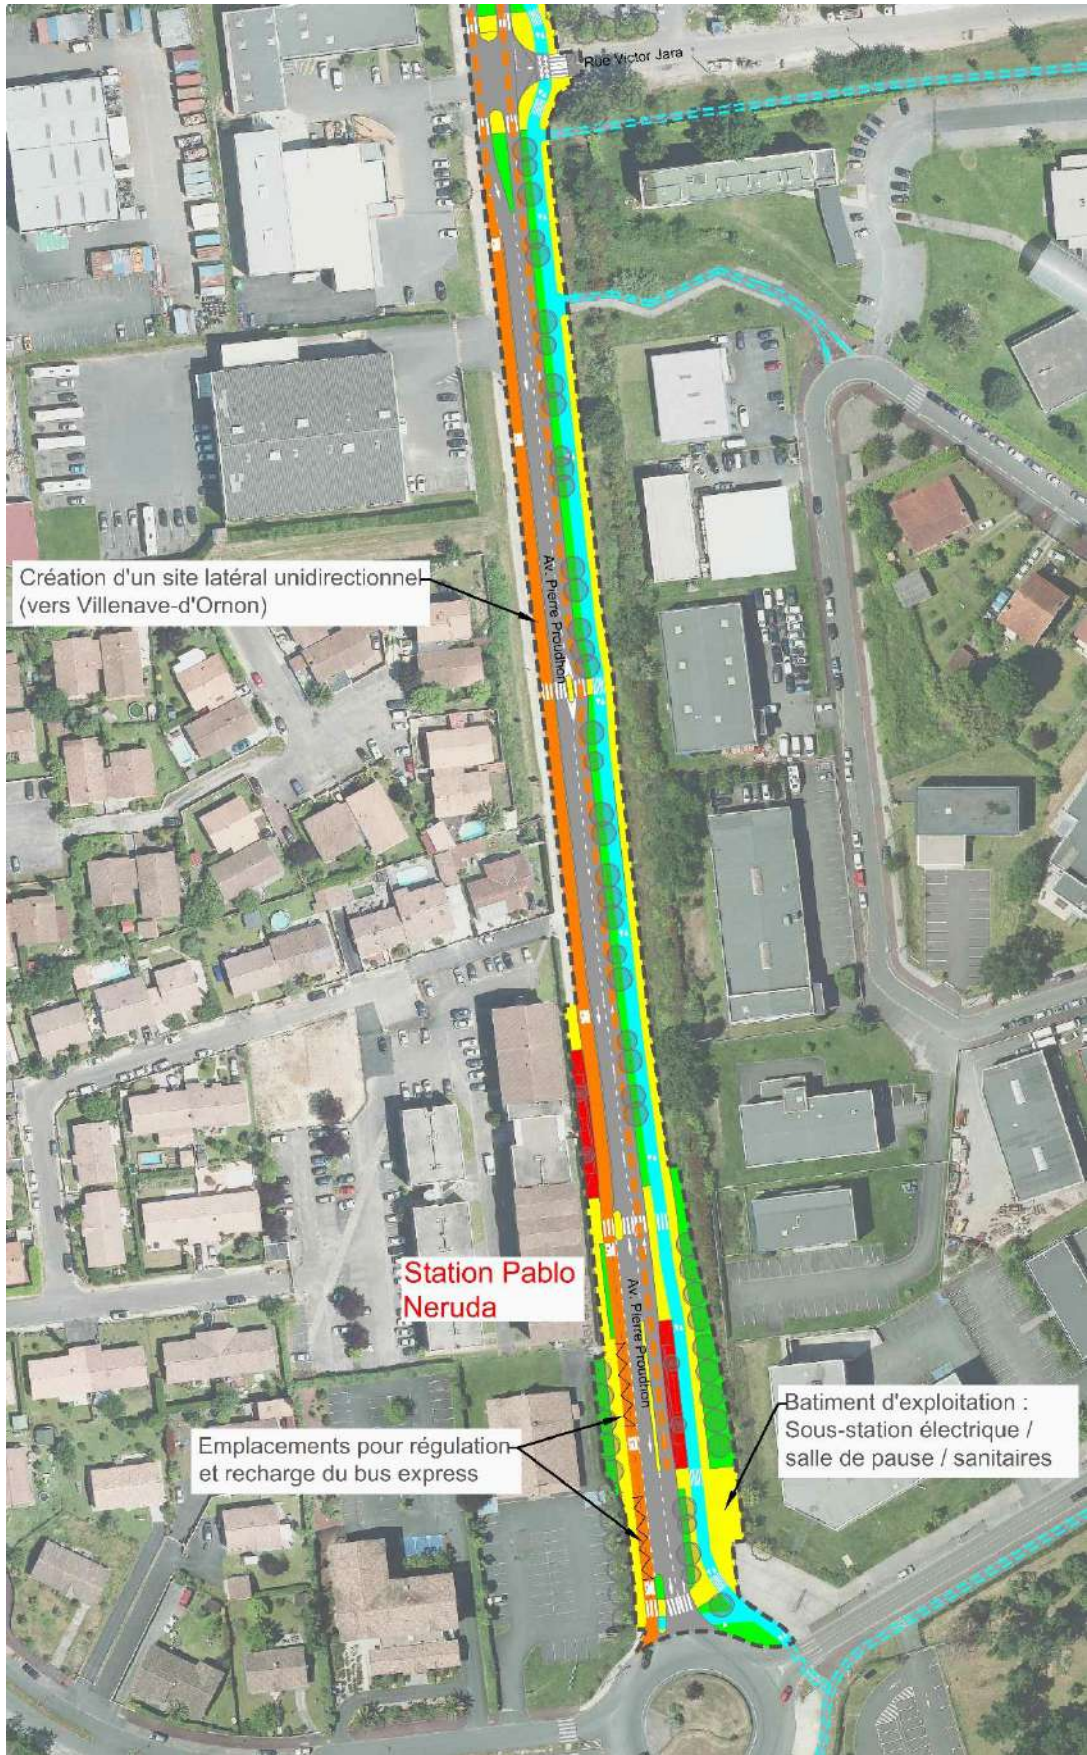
Extraits de plan sur l'insertion sur l'avenue Pierre Proudhon
